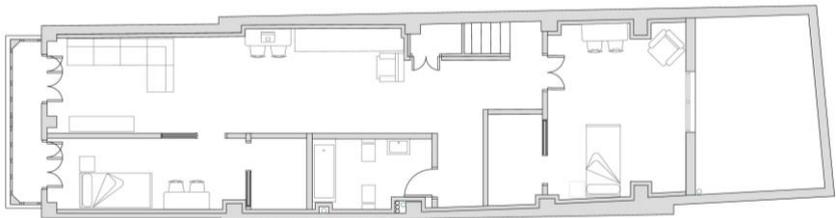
Distribución estancias planta segunda. 2018. Fuente: Propia
